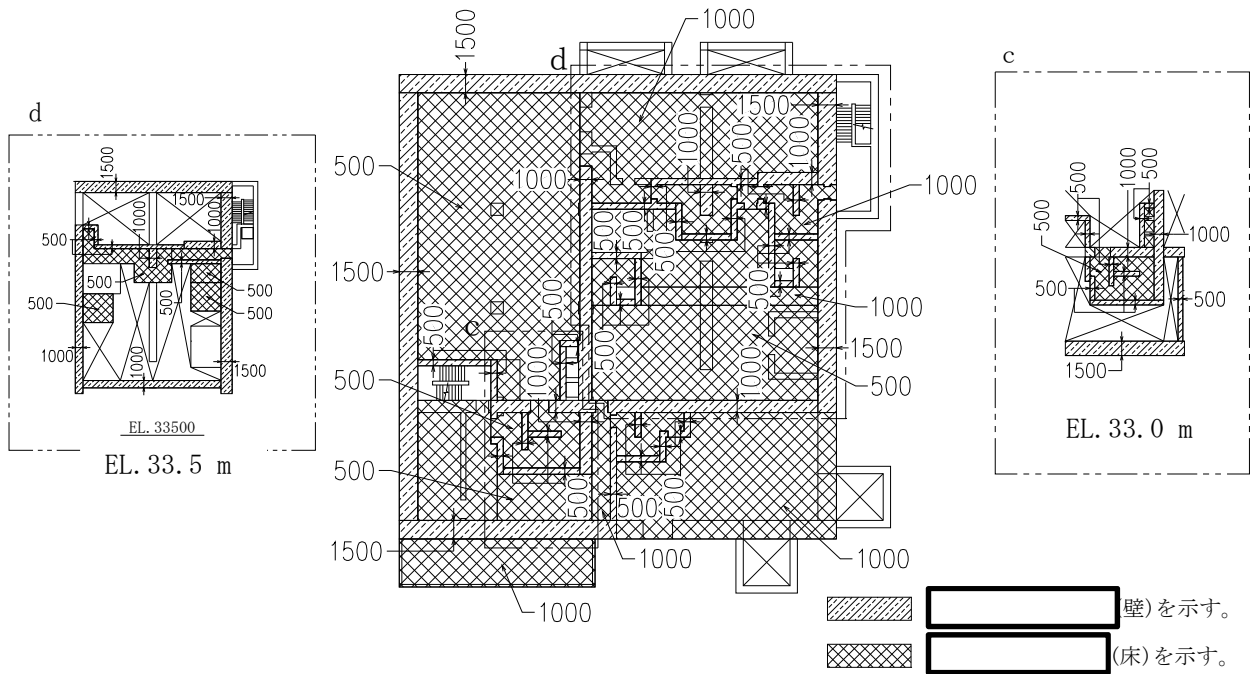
(2/7)  の範囲 (2 階平面図 : EL. 30.3 m)
